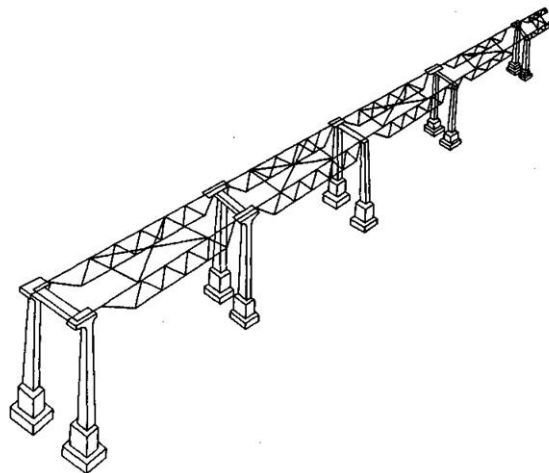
Естакада з пролітною будовою для прокладання трубопроводів
